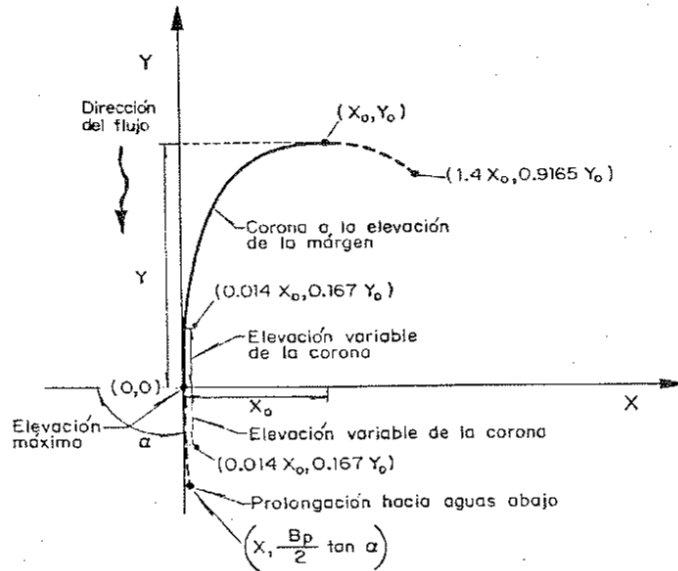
Geometría y elevación de la cresta de un dique de encauzamiento.
